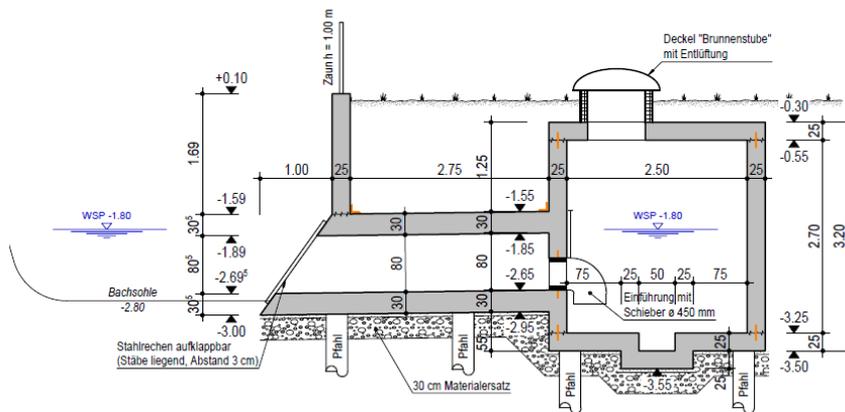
; Planausschnitt Wasserfassung Erlenbach
